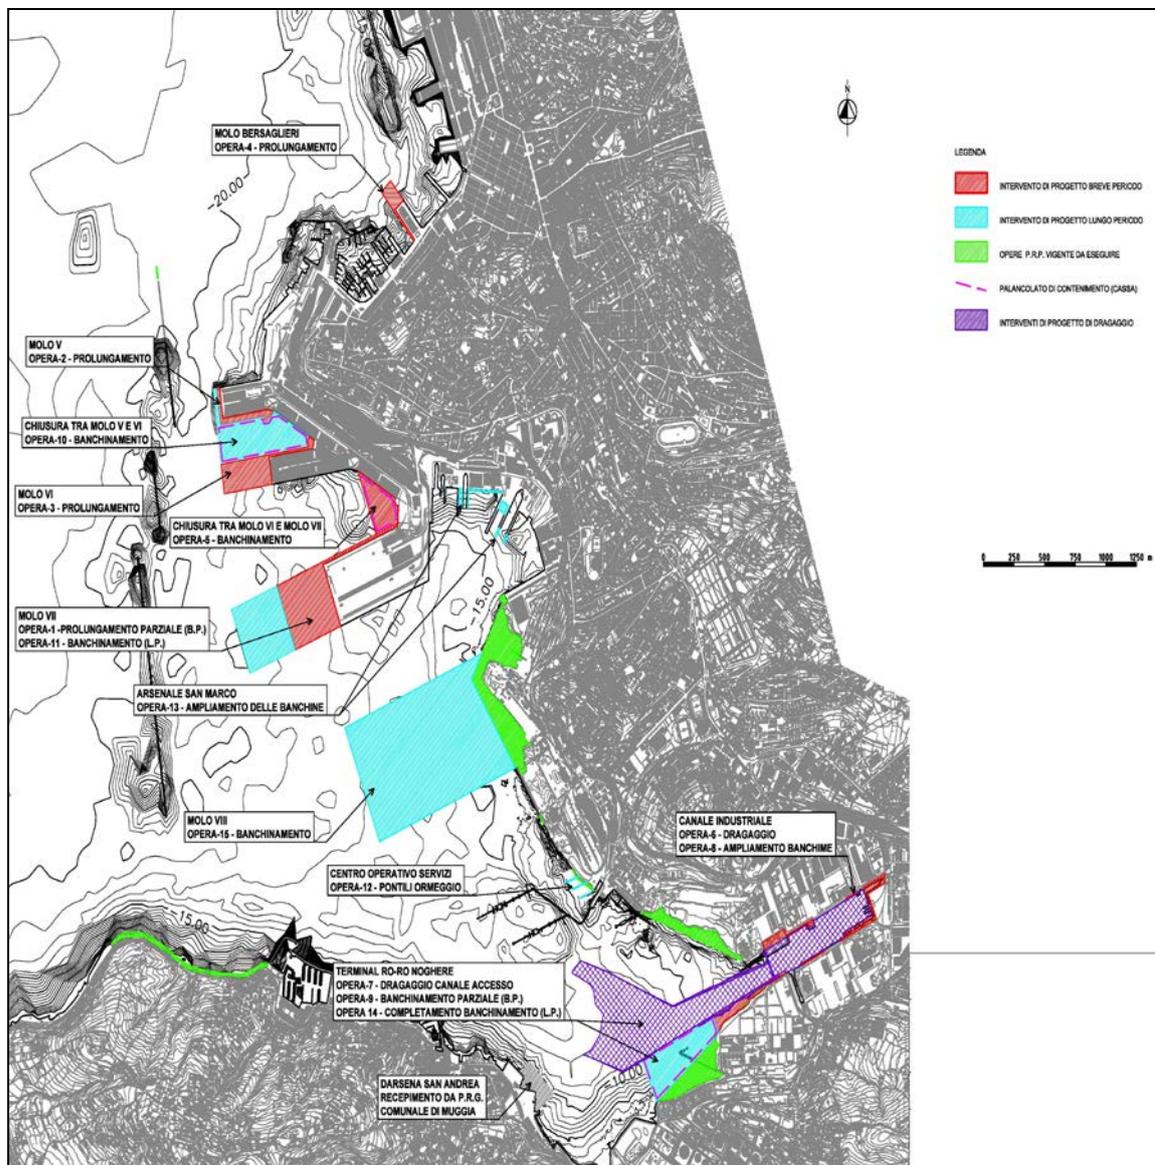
PLANIMETRIA DEGLI INTERVENTI DI BREVE E LUNGO PERIODO
